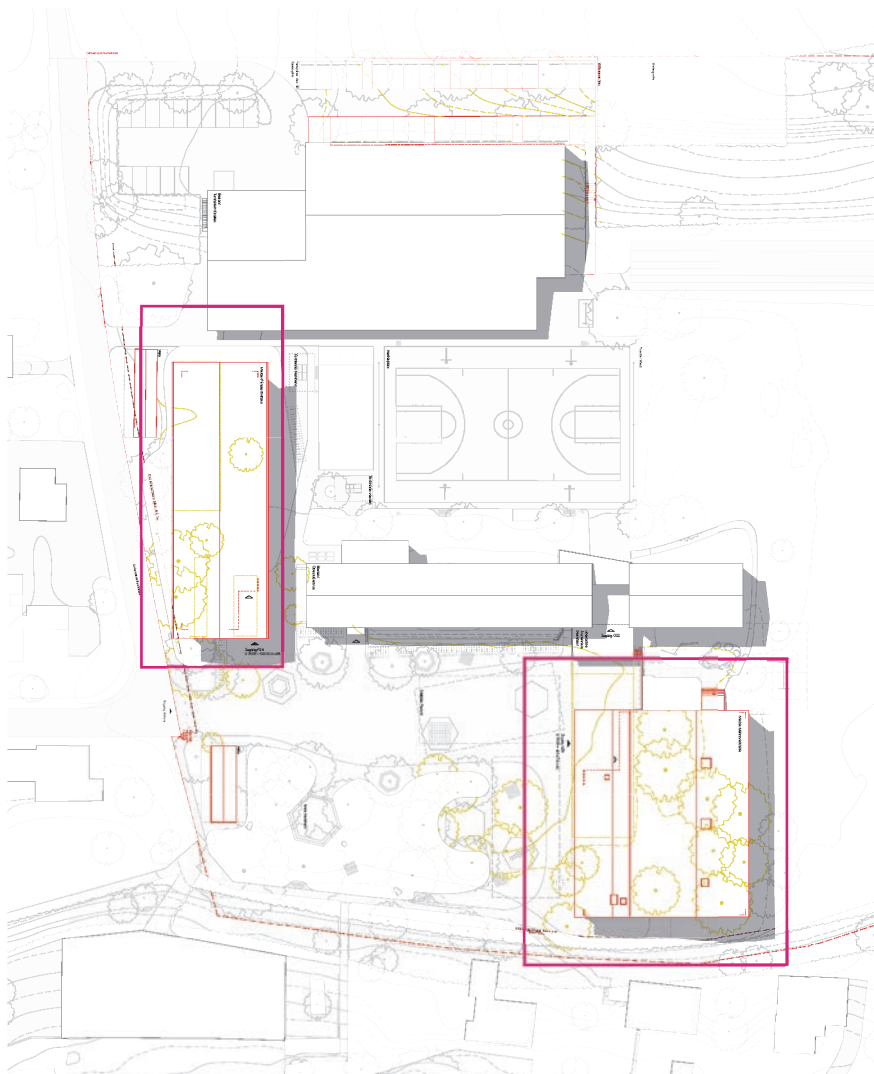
Bauprojekt Dachaufsicht mit neuen Gebäudevolumen pink umrahmt, Quelle: Schmid Schärer Architekten
